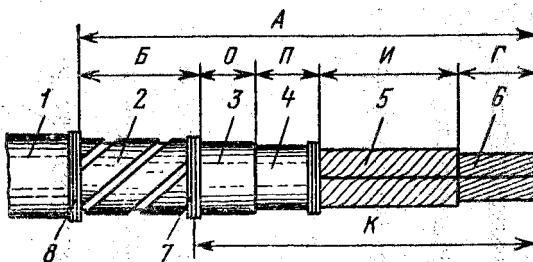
Разделка трехжильного кабеля с бумажной изоляцией:
